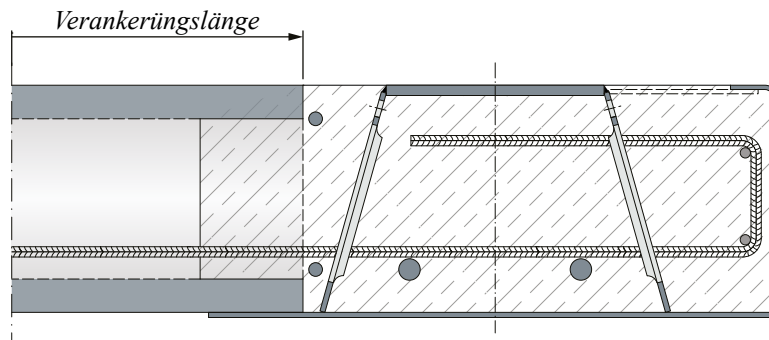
DELTABEAM® D-Profil als Randträger mit Quer- und Ringankerbewehrung
